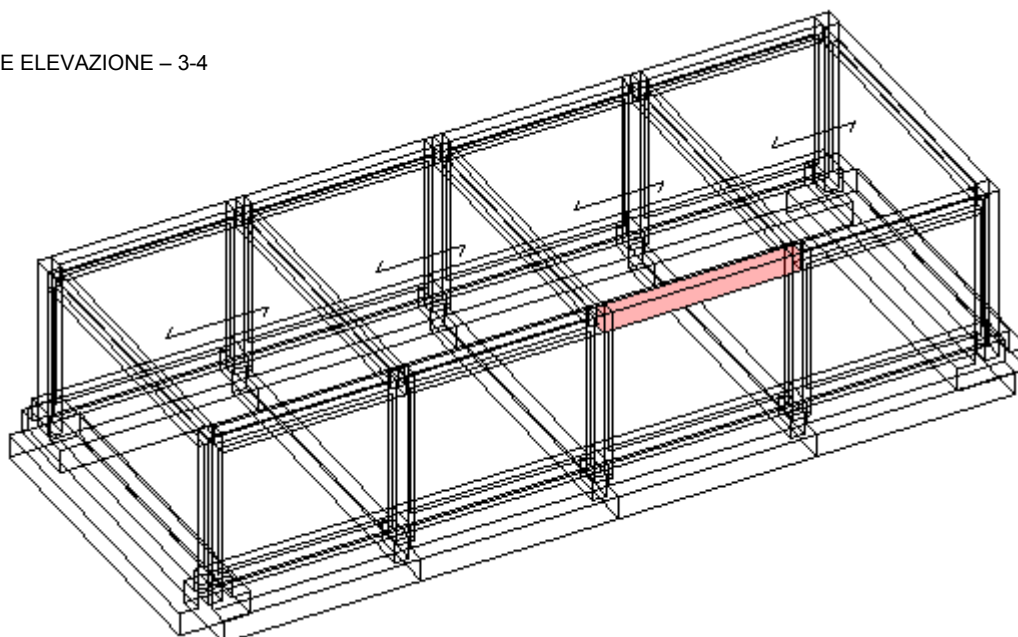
Modello di analisi - Travi di elevazione 3-8/3-4
